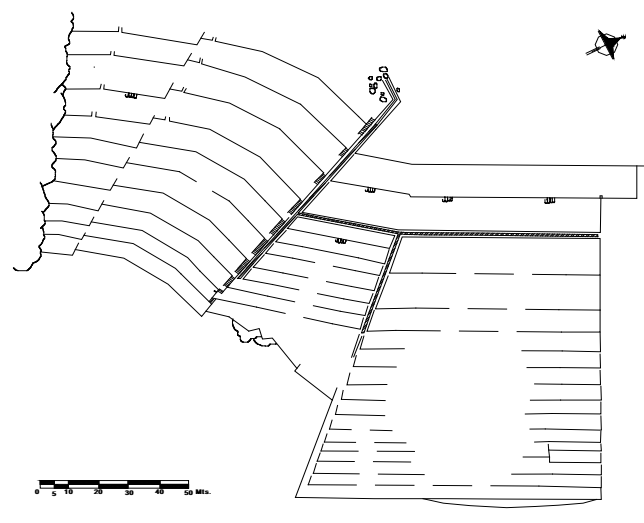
Plano del sector X (Fuente Plan COPESCO 2004)
